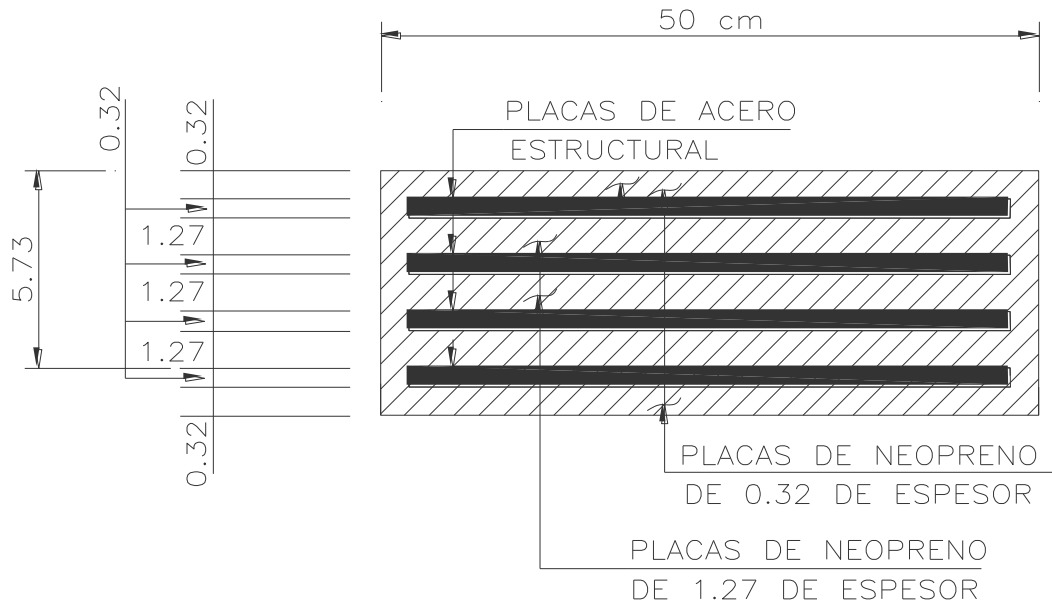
Vista en perfil del apoyo de neopreno
